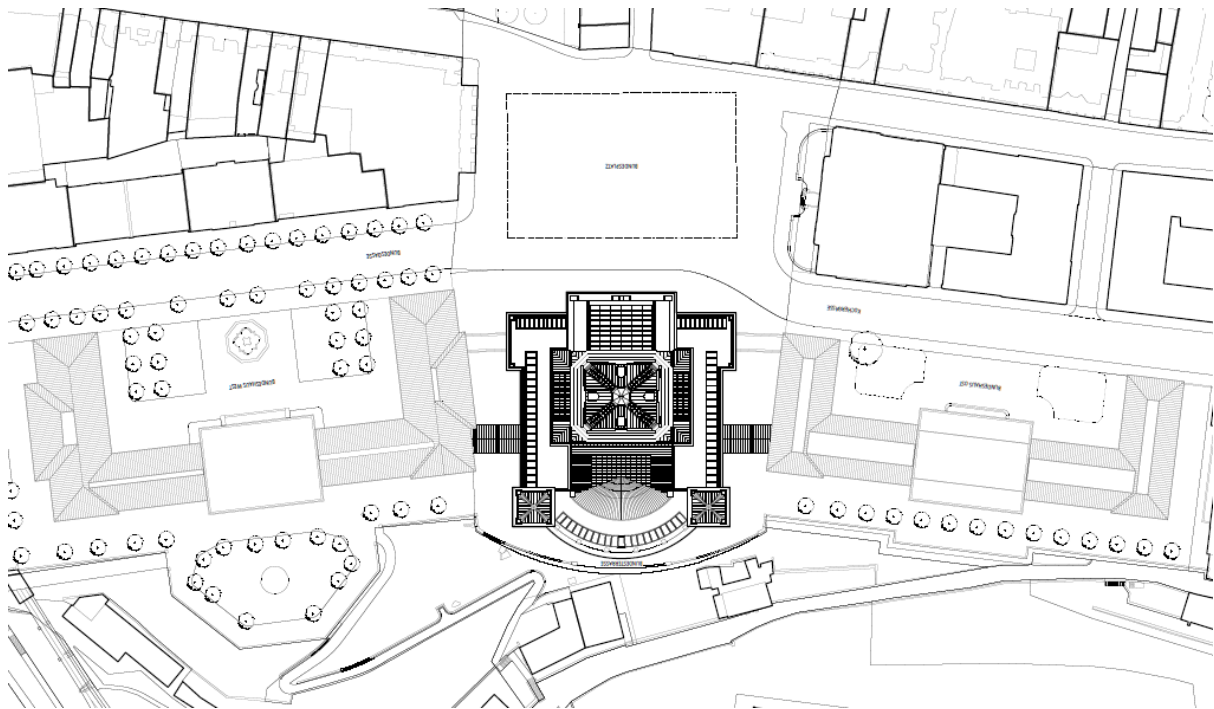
Lageplan (Bundeshaus Hanspeter Winkler / Monika Biffinger, Bundesamt für Bauten und Logistik 2008)
